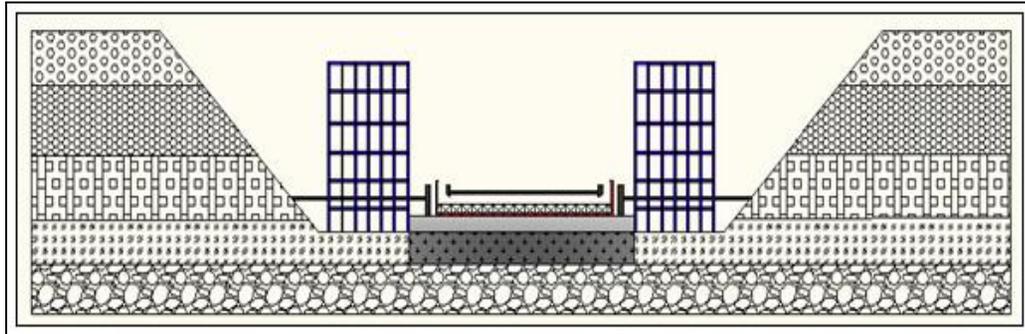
Encofrado externo e interno de la losa estructural inferior.
